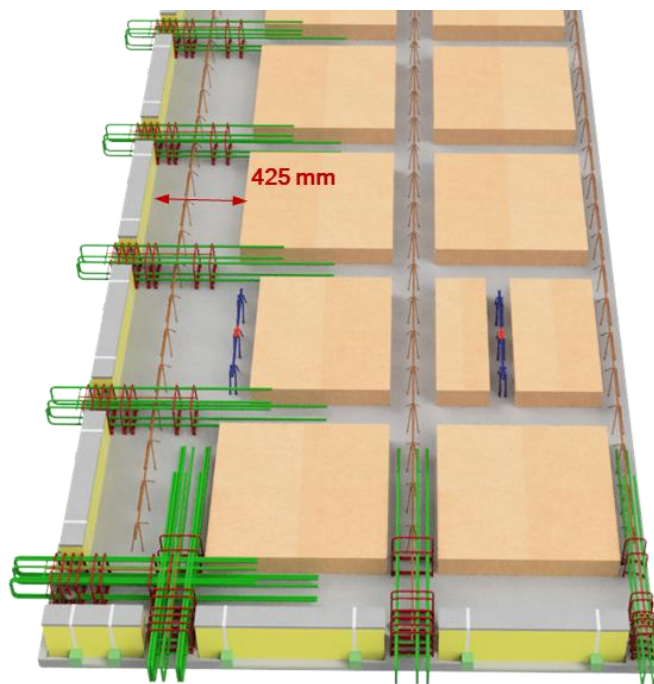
position de la 1^{ère} rangée de blocs d'égissement en rive de plancher
